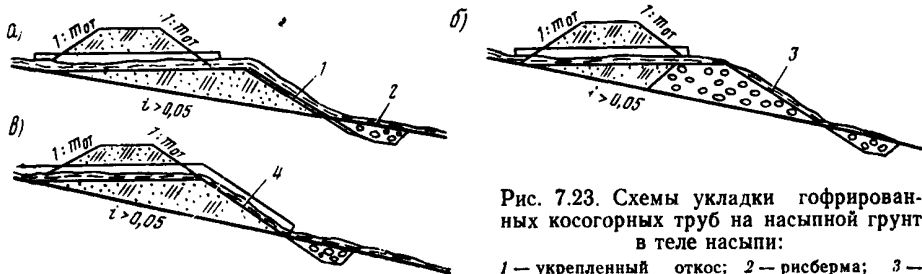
Схемы укладки гофрированных косогорных труб на насыпной грунт в теле насыпи:
